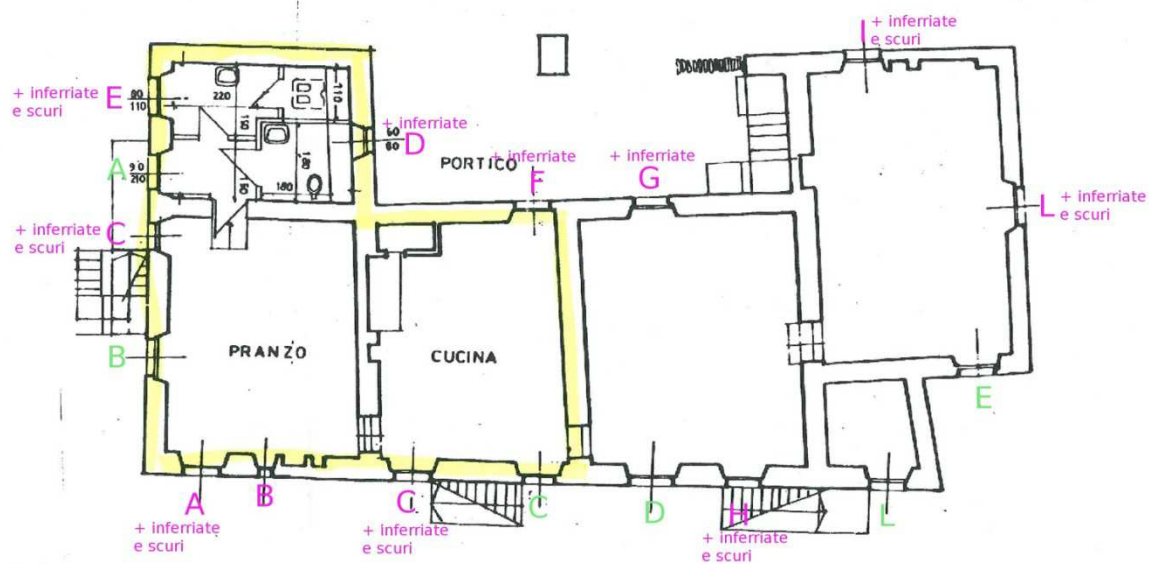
planimetria del piano terra di Ca' Soldato
